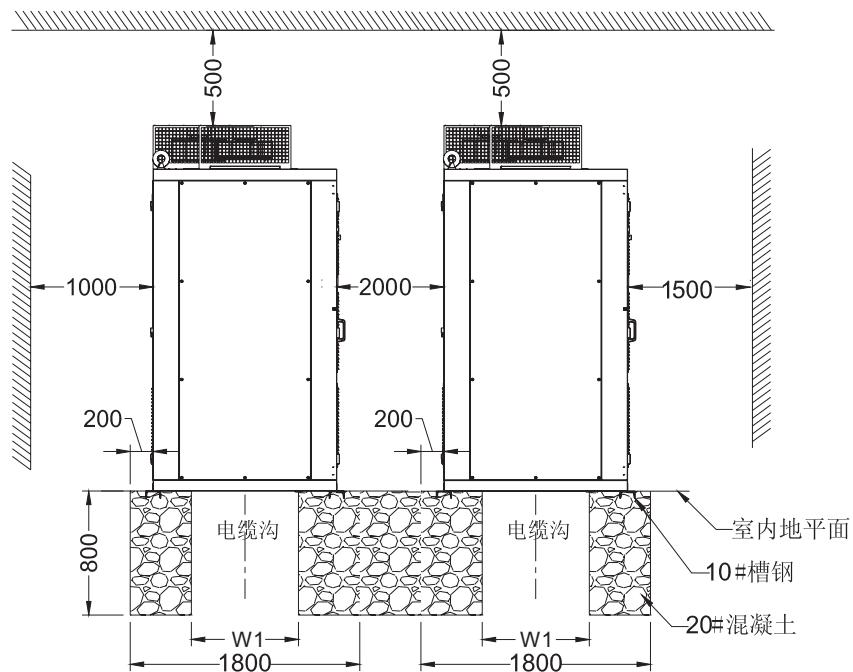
高压变频器安装要求示意图 1 (正视图, 单位: mm)
